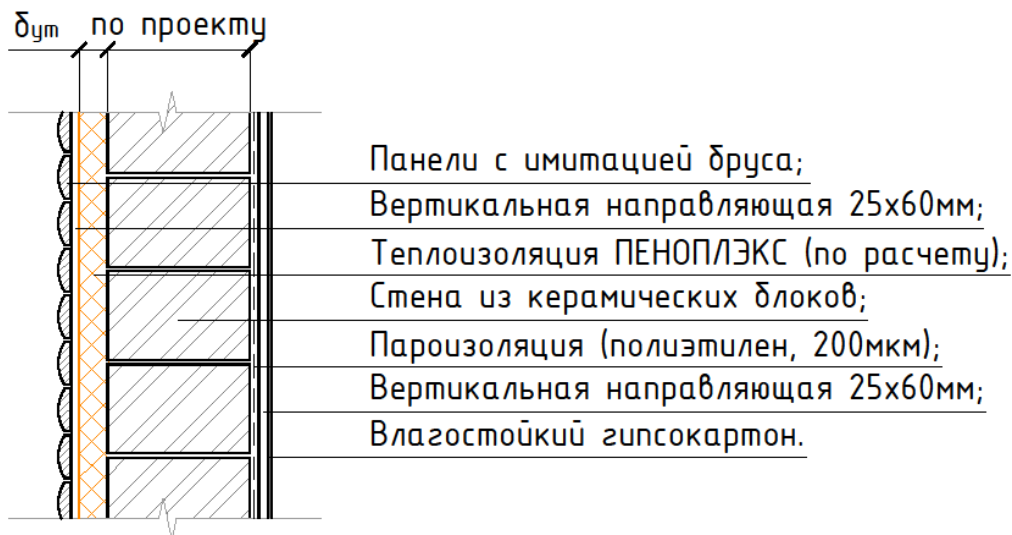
Схема внешней отделки фасадной доской/сайдингом.
